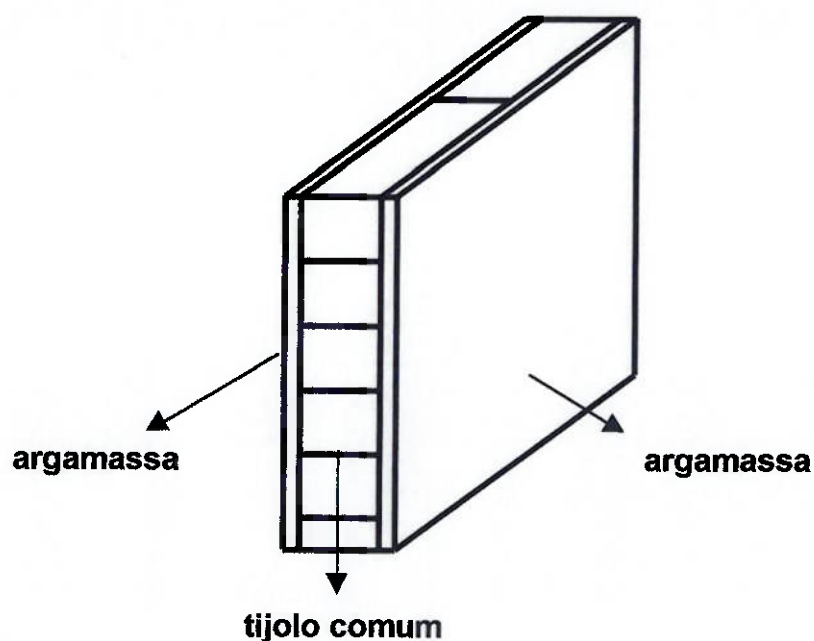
Disposição das camadas de materiais das paredes, teto e piso.
